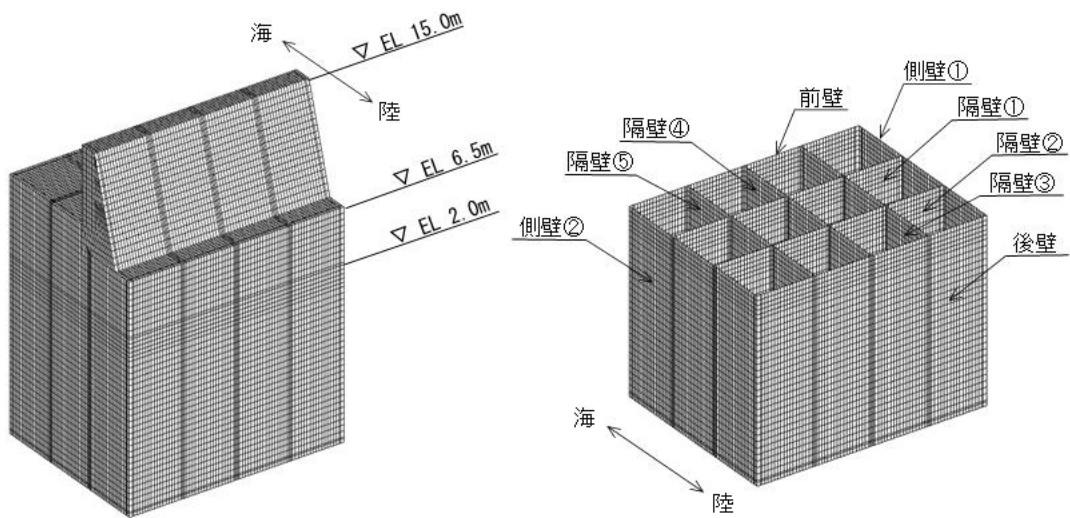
(3) ケーソンの構造部材 (④-④断面)
